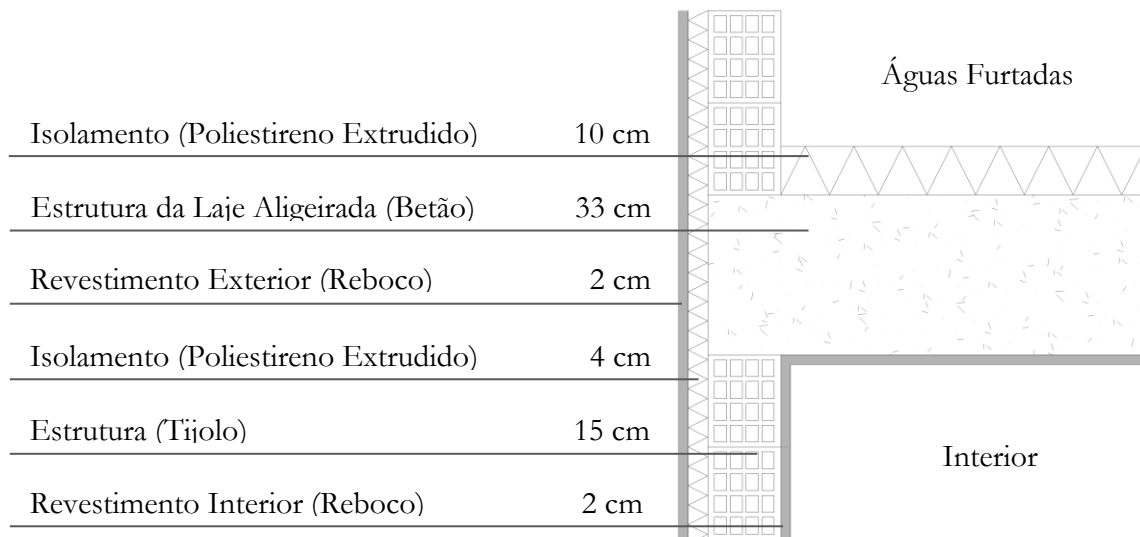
Constituição das Paredes Exteriores e da Laje de Teto
